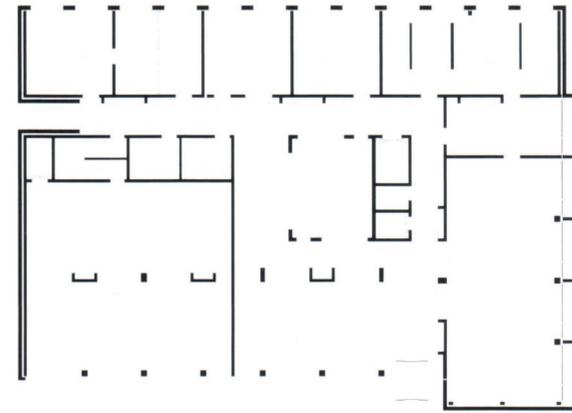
Grundriss Erdgeschoss M 1:500
